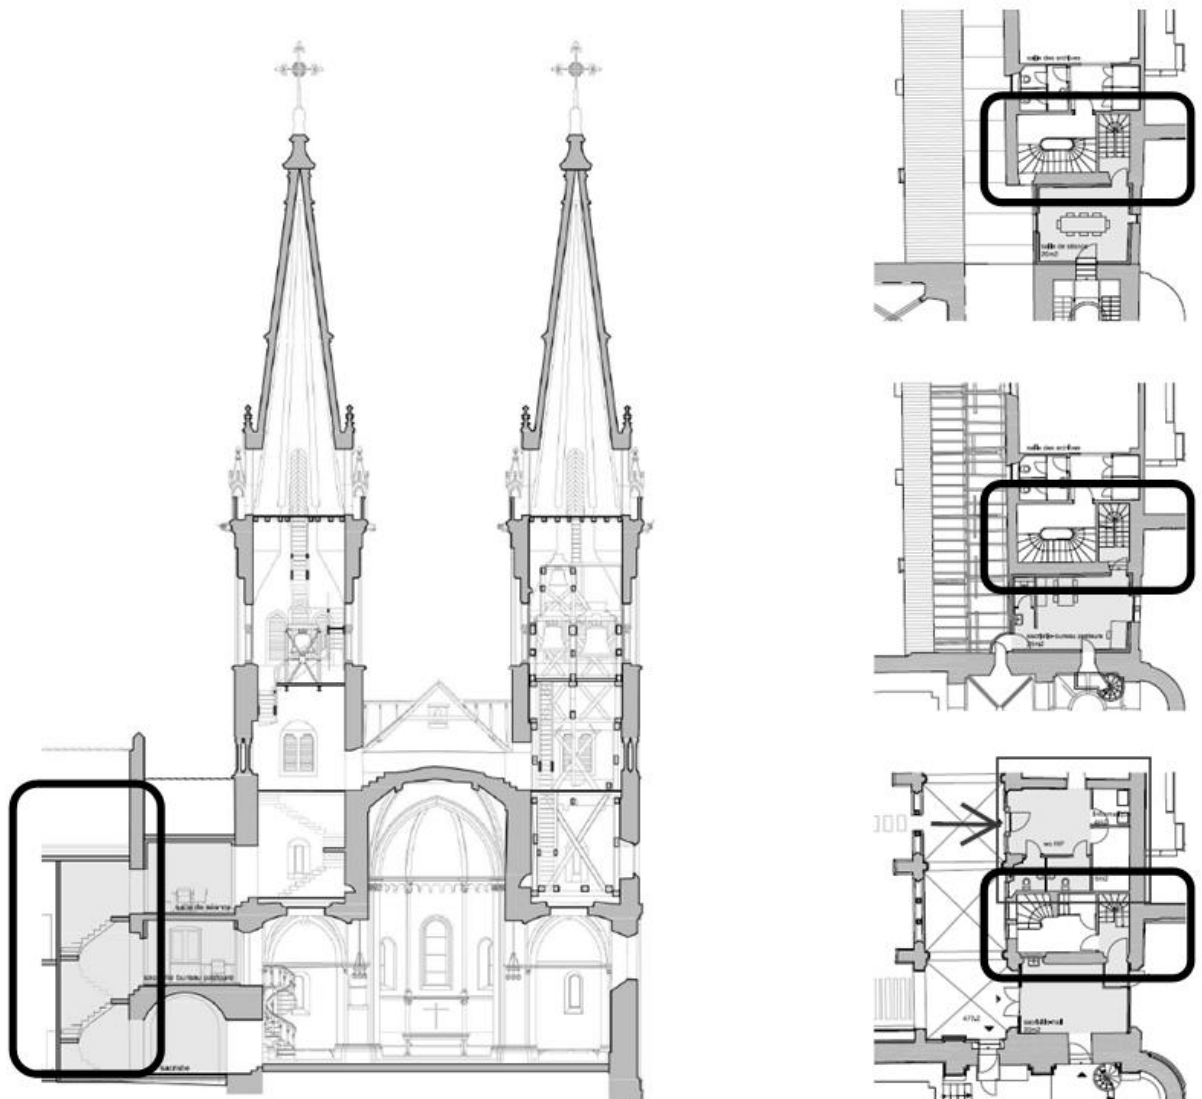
Coupe et plans (du rapport 14-005, page 41). Les rectangles marquent les deux escaliers existants
